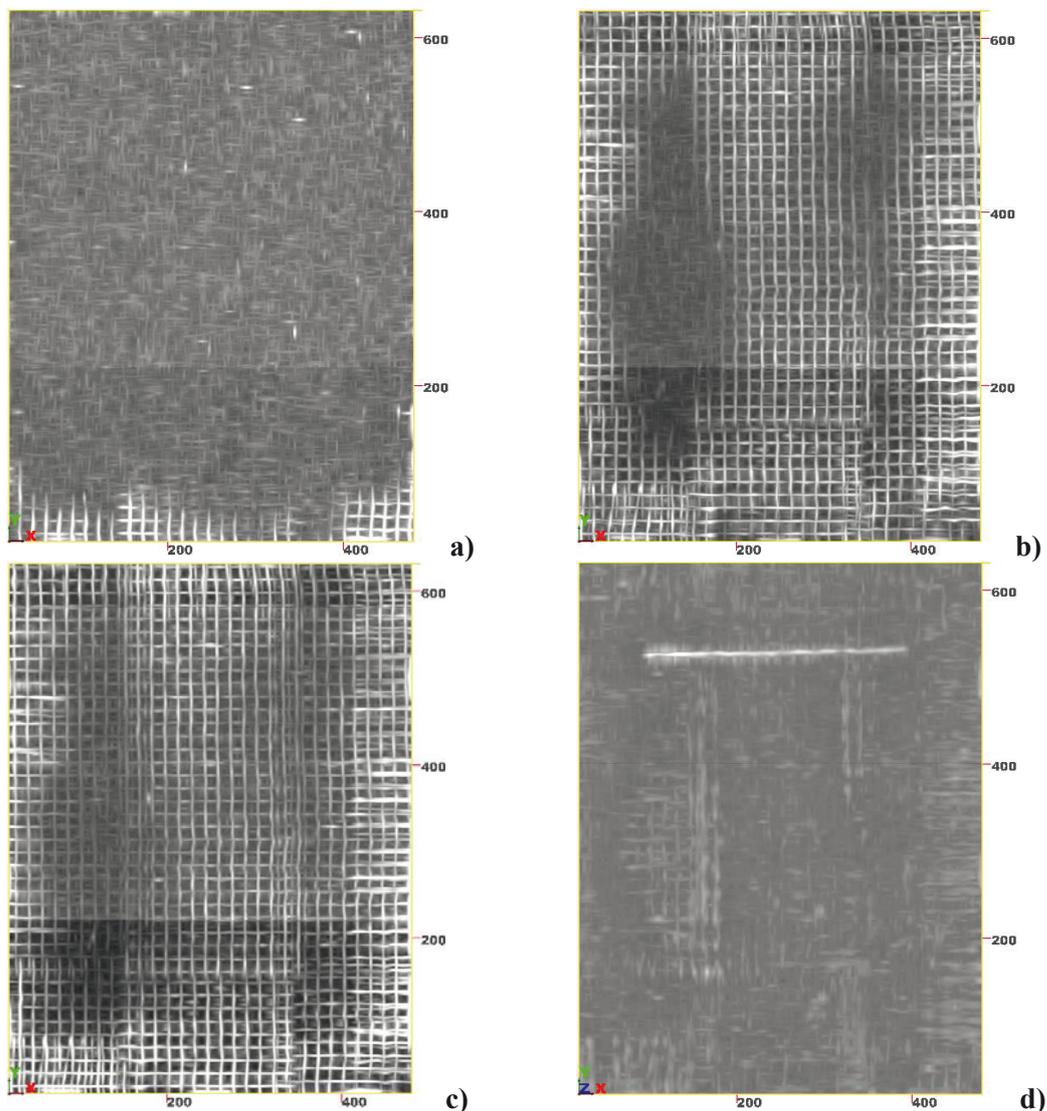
Radar-Horizontalschnitte (C-Bilder). a) 5 cm Tiefe: Geringste Betondeckung der Bewehrung am unteren Rand. b) 9 cm: gesamte Bewehrung bis auf Tieflagen (dunkle Stellen) c) 7-13 cm: gesamte Bewehrung, Bügel und
